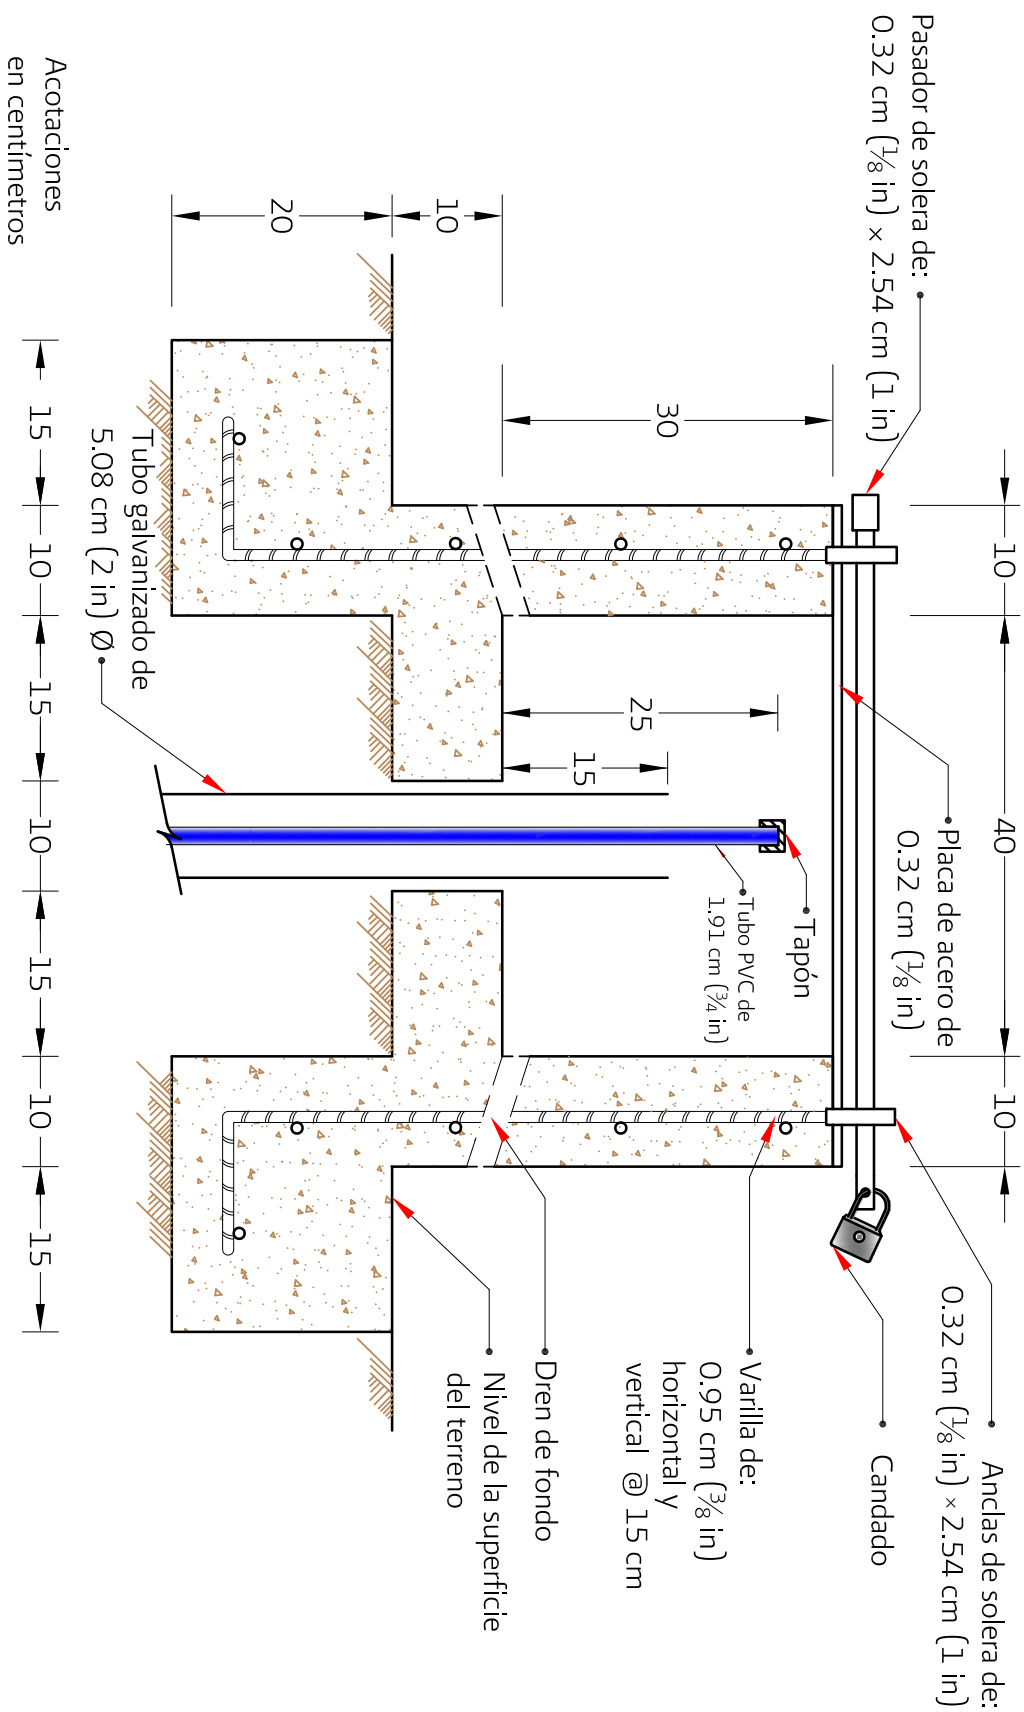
Caja de concreto armado para protección del brocal del piezómetro abierto
